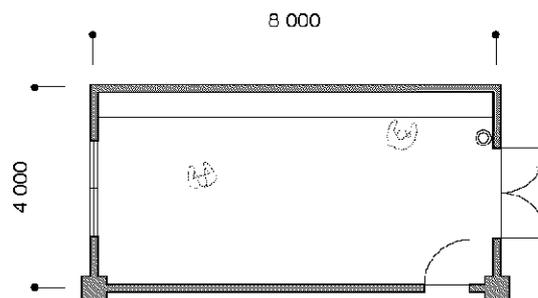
(29) Plan de la chambre de conservation de poissons salés
